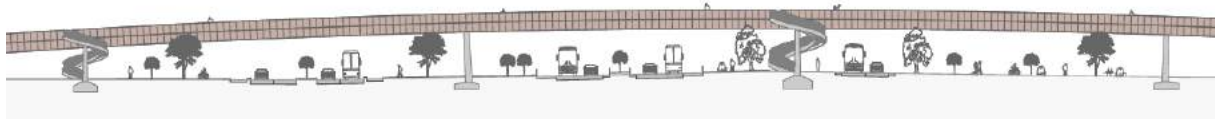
Recorte del plano “Detalles del perfil longitudinal” tramo PK 0+366.00 – PK 0+549.00
